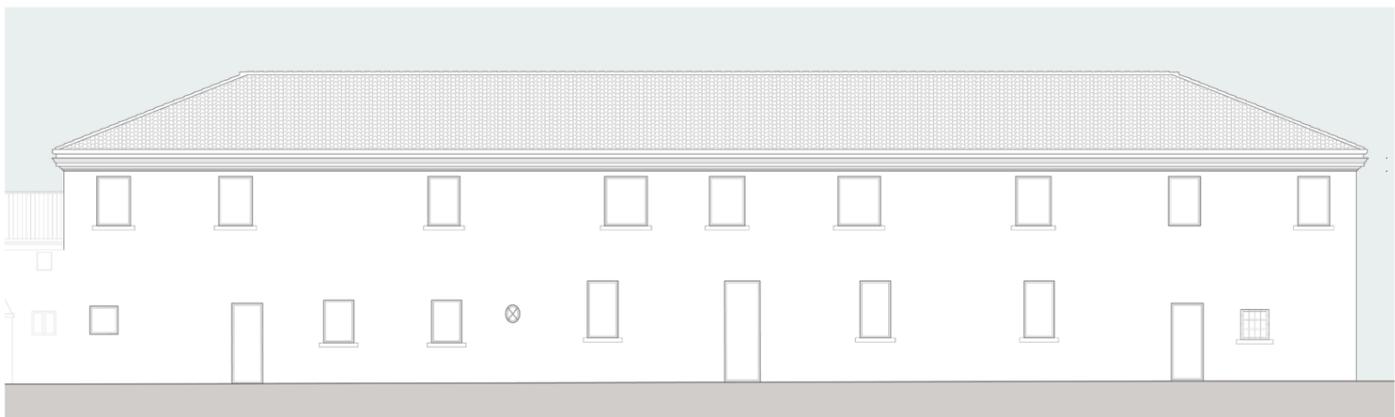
Prospetto est, rilievo geometrico, scala 1:200
